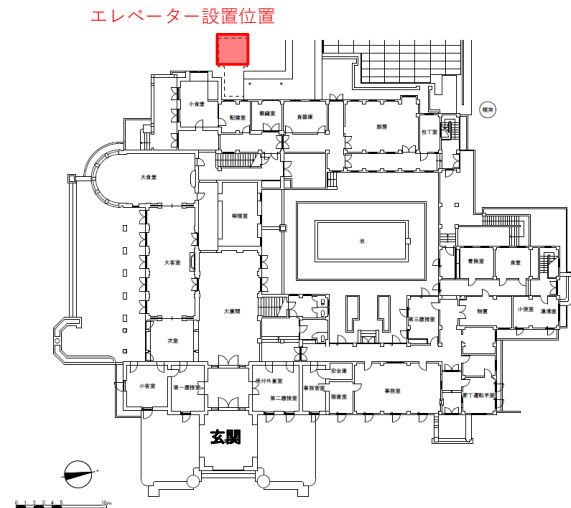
本館 1 階平面図 (赤色はエレベーター設置位置)
